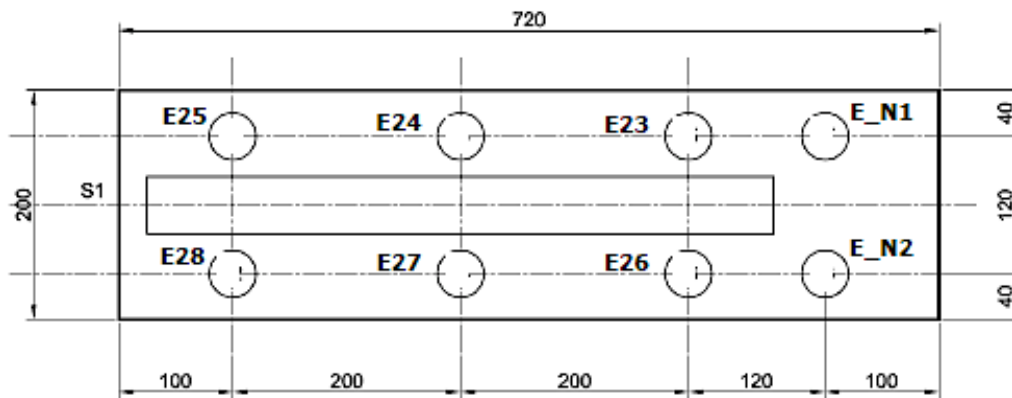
Planta esquemática do bloco de fundação após o reforço estrutural, OAE 09L, TTN, Brasília, DF. Fonte: DER/DF, 2018
